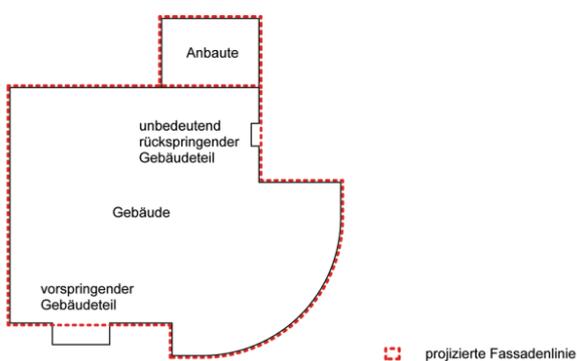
Figur 3.3 Projizierte Fassadenlinie, IVHB
